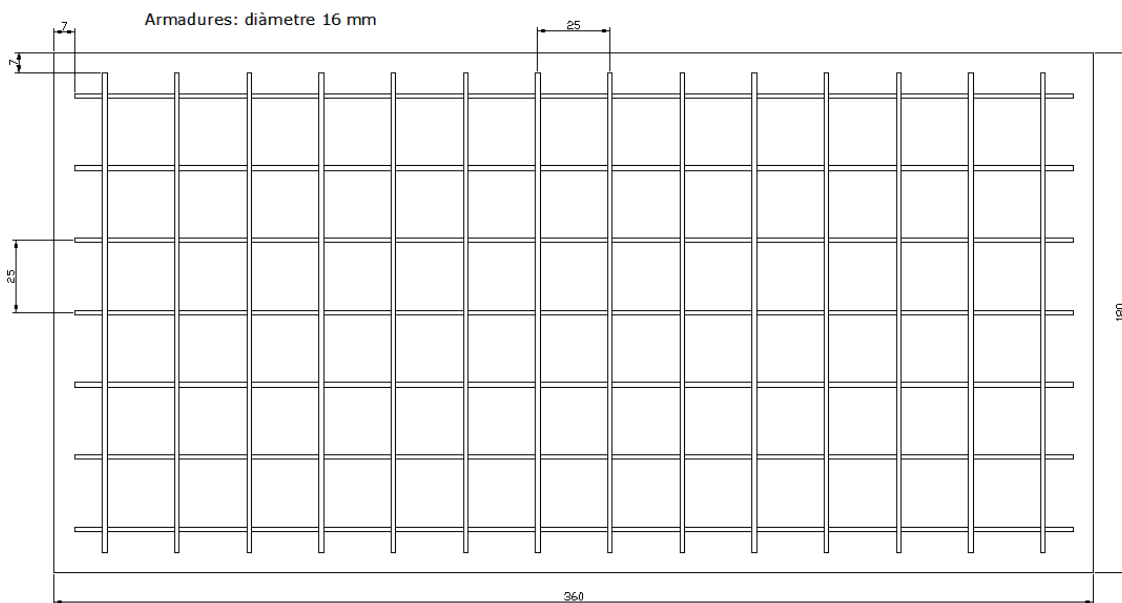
Armat de les sabates dels pilars hastials vist en planta (Font: Autocad)
